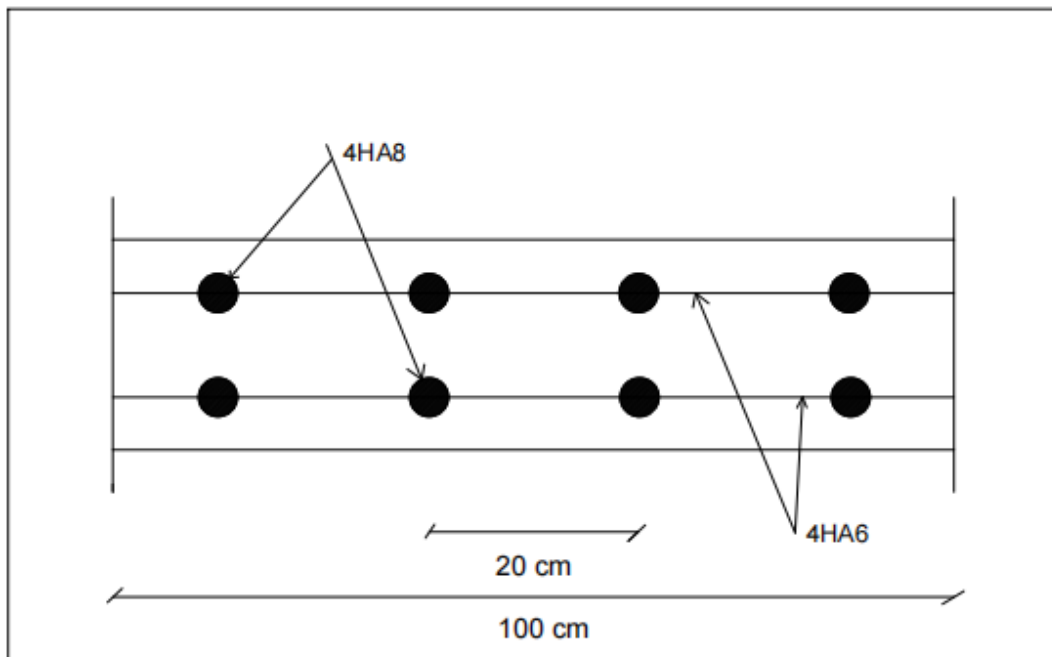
Schéma de ferrailage de l'acrotère coupe B-B.
